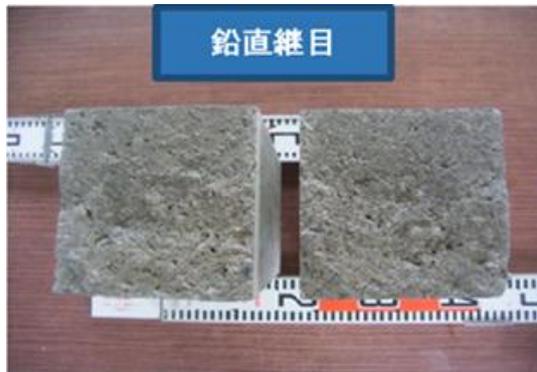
前回の鉛直継目の破断面 (90分経過) 写真-2 今回の鉛直継目の破断面 (90分経過)
